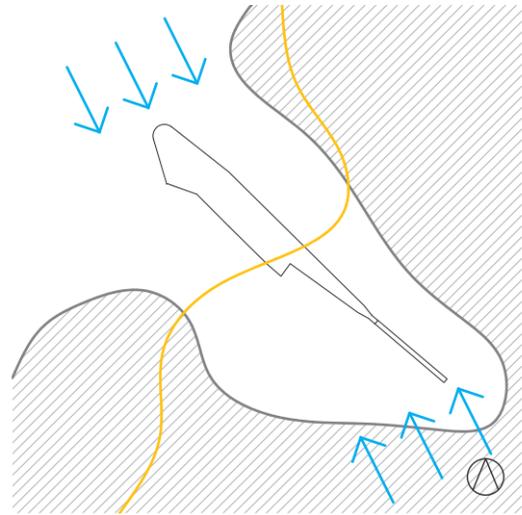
Grundriss Erdinger Arena Oberstdorf M 1:2.000
